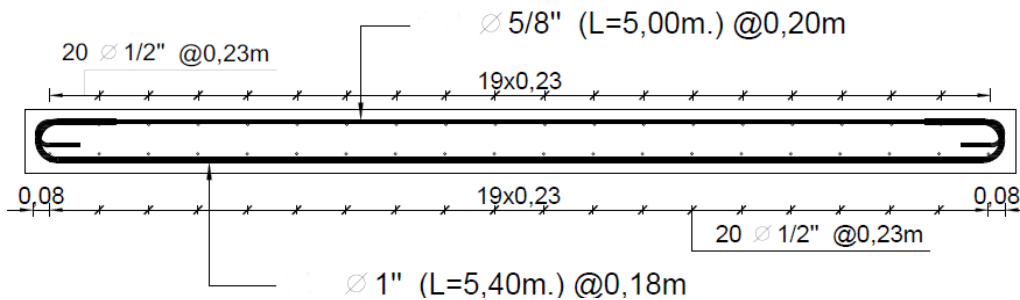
Armado Final de la Losa de 30cm. Fuente: Autores
